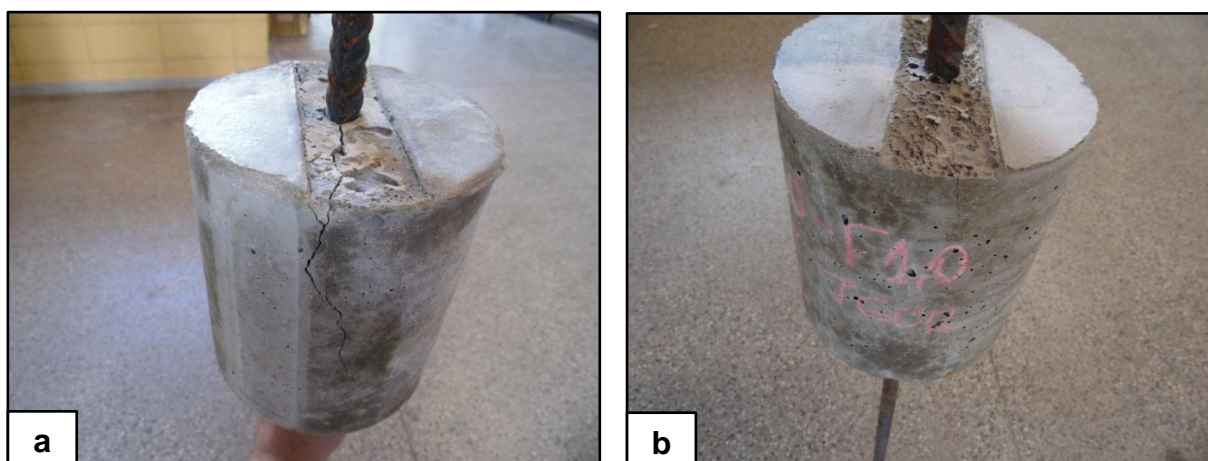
(a) e (b) - Ruptura e fissuração dos corpos-de-prova da classe de 60 MPa.
